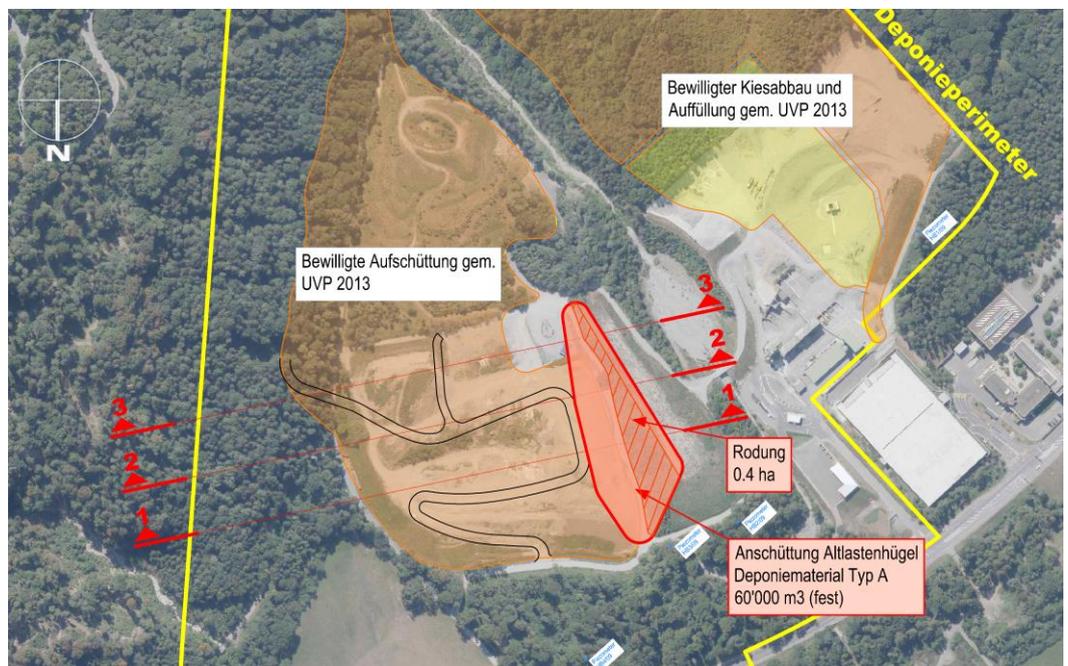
Planausschnitt Rodungsetappe für Anschüttung Altlastenhügel, Rodungsfläche rot gestreift dargestellt
